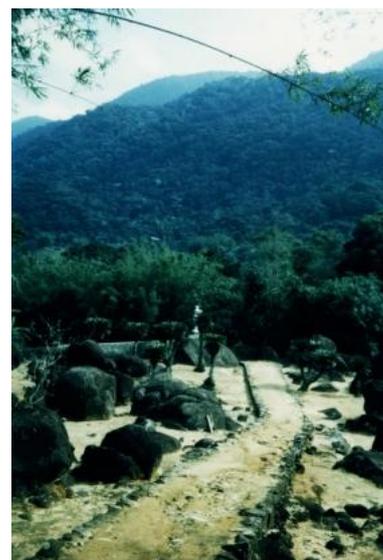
Vista do acesso para as captações das Barragens Inferior e Superior
